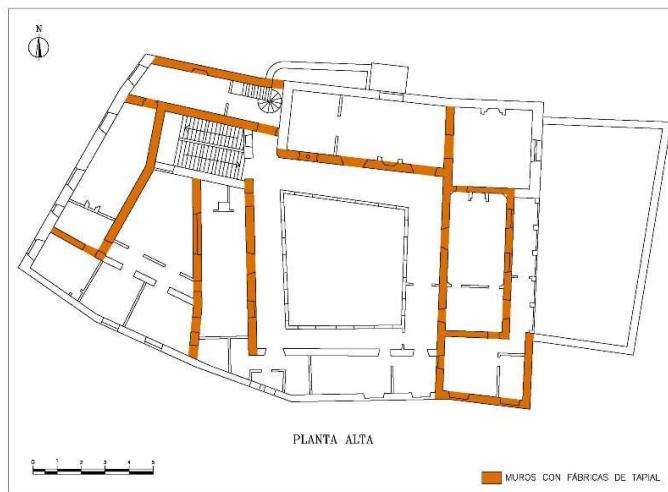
Casa de Calle San José 3. Planta alta. Muros constatados en tapial
